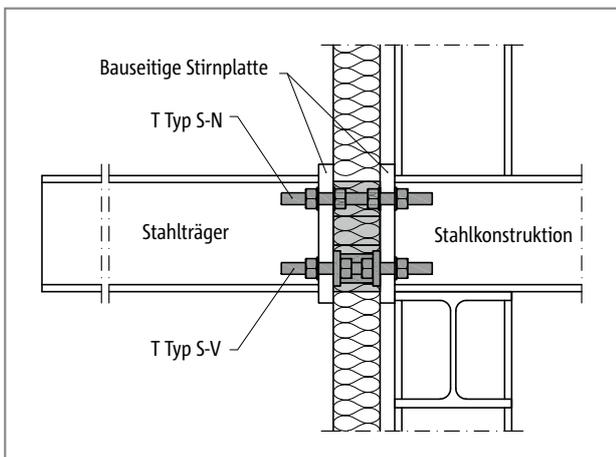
Schöck Isokorb® T Typ S-N und T Typ S-V: Stahlkonstruktion frei auskragend
